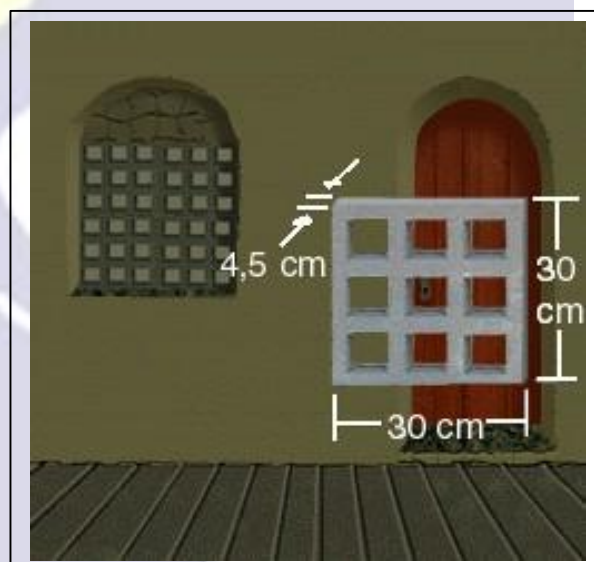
Elemento vazado de argamassa de cimento, regular, 30,0 X 30,0 cm
